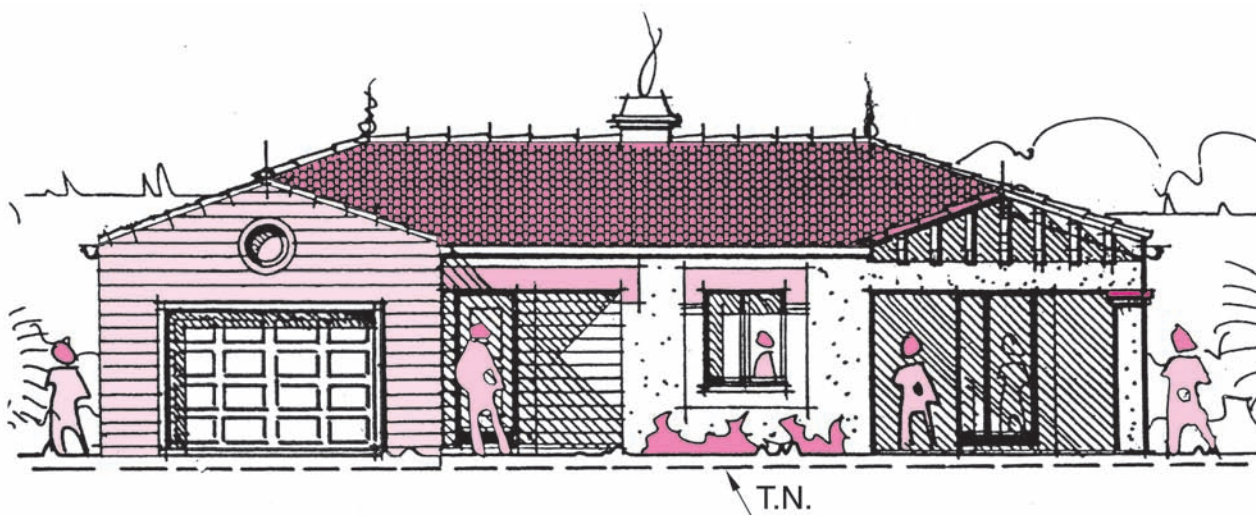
Élévation de la façade Ouest sur rue avec les entrées principale et de garage
